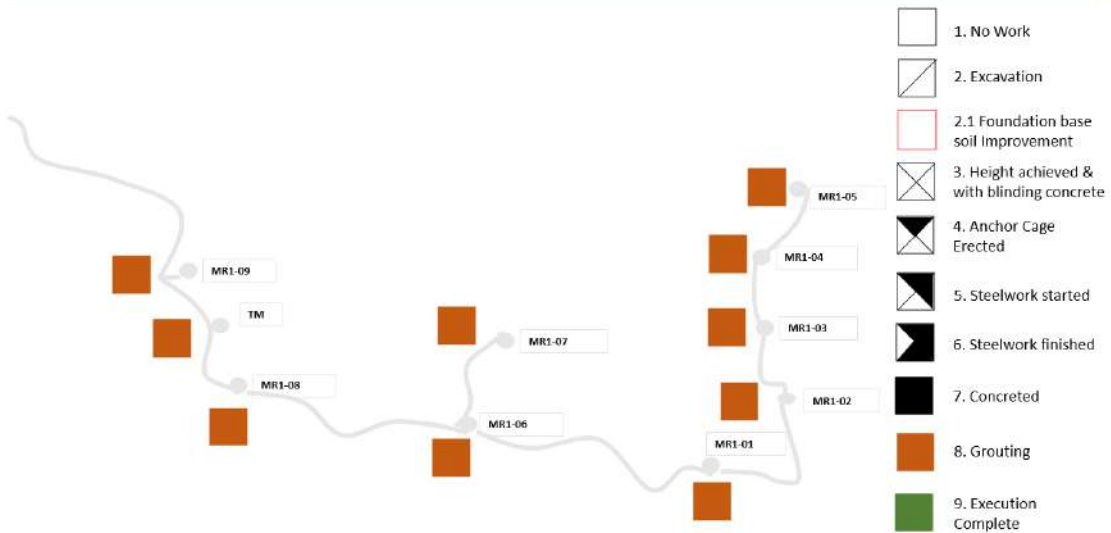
Estado y plano de obras ejecutadas a fin de mes.
